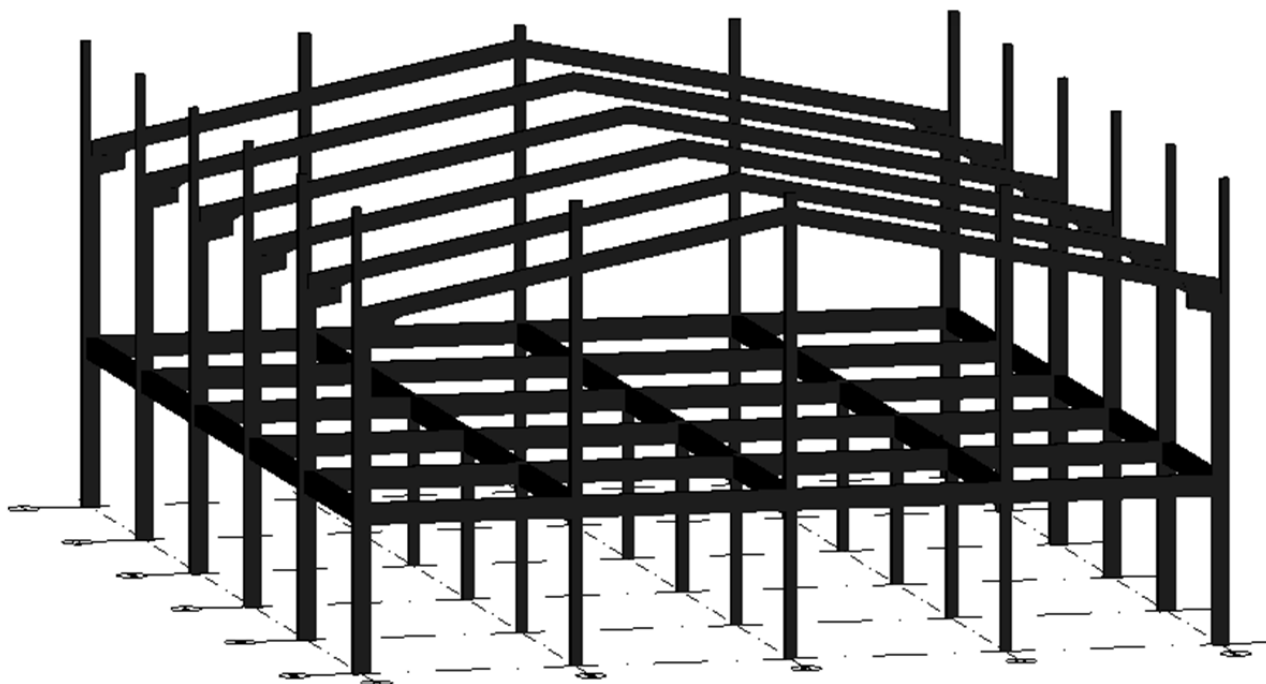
Perspectiva da estrutura em concreto pré-moldado.
